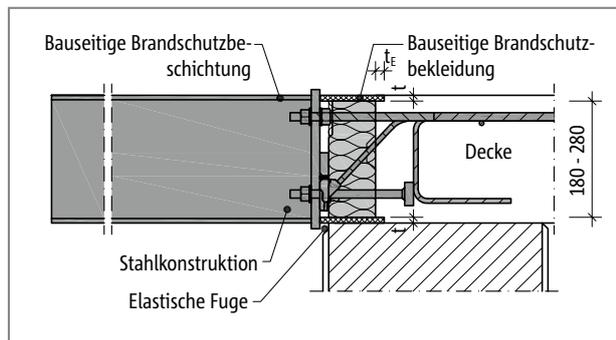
Schöck Isokorb® T Typ SK: Bauseitige Brandschutzbelegung T Typ SK, brandschutzbeschichtete Stahlkonstruktion; Schnitt
